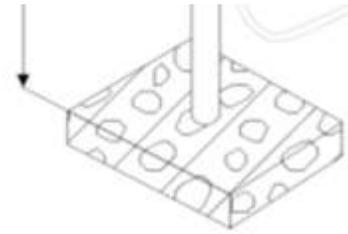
Schizzo della fondazione con lastre di pavimentazione
